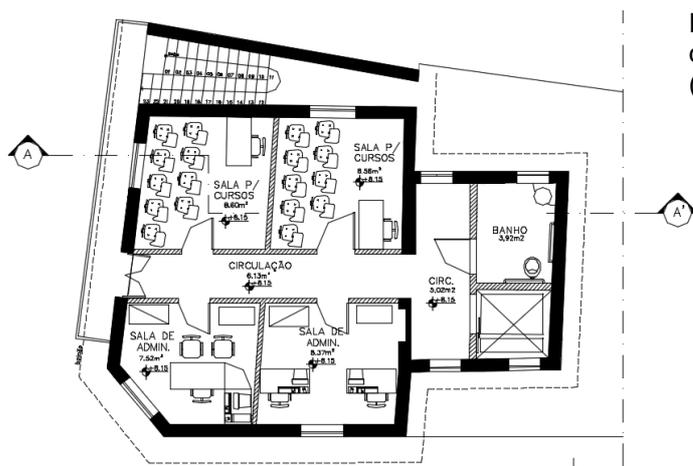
Planta baixa do 1º pavimento do projeto de recuperação da quadra 07A (para melhor visualização ver anexo A)
